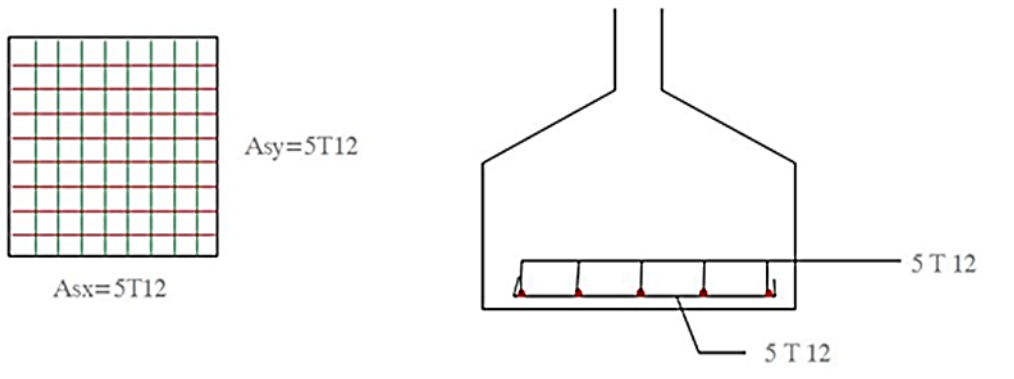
Schéma de ferrailage pour la semelle (S1).
